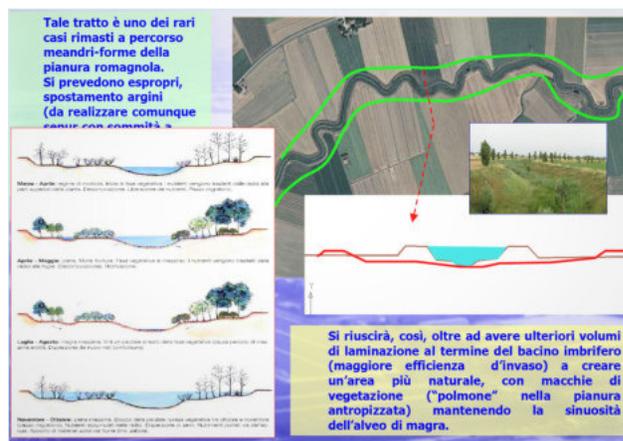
Sezione tipo dell'intervento sul torrente Bevano
